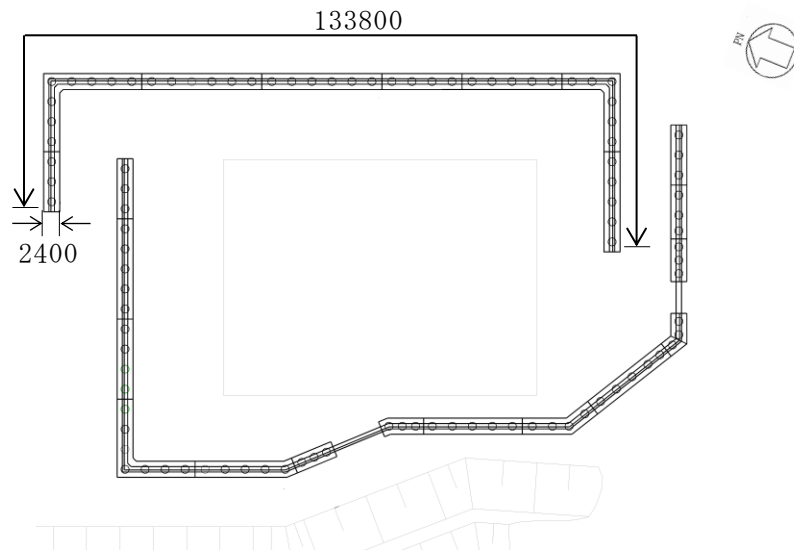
免震重要棟遮蔽壁の概要図（平面図）（単位：mm）
